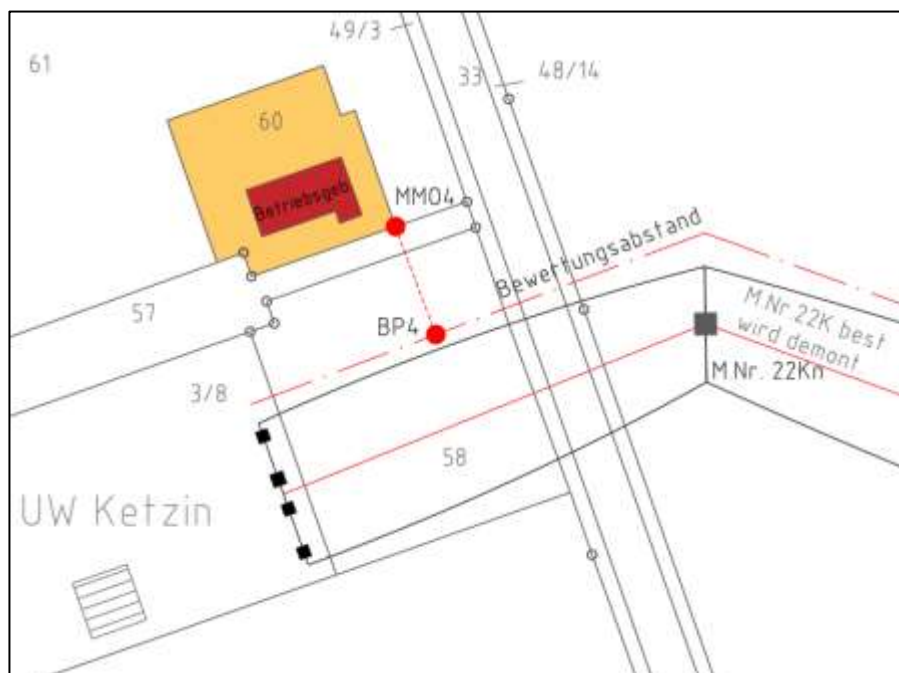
Lageplanausschnitt mit dem Minimierungsort 4
